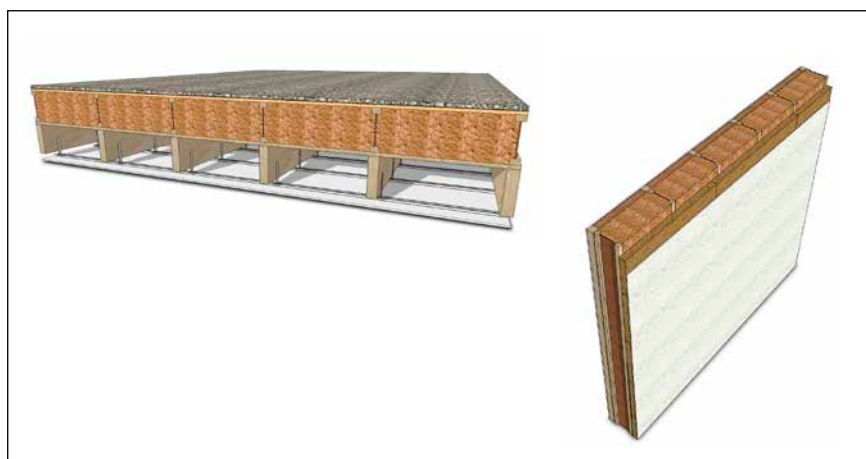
Struktureller Aufbau der Holzbauelemente des Gebäudes. Links obere Geschosdecke, rechts Außenwand. Beschreibung siehe Text
